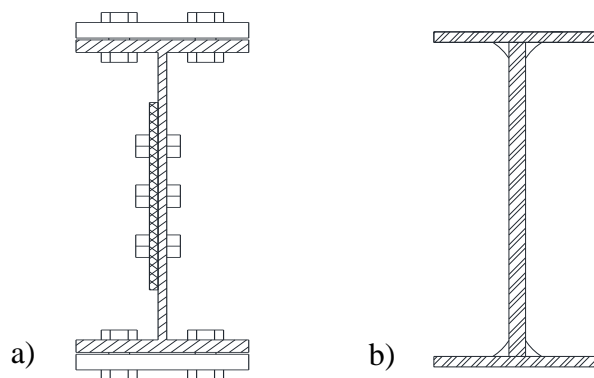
Viga Armada con Planchas Empernadas y Soldadas
